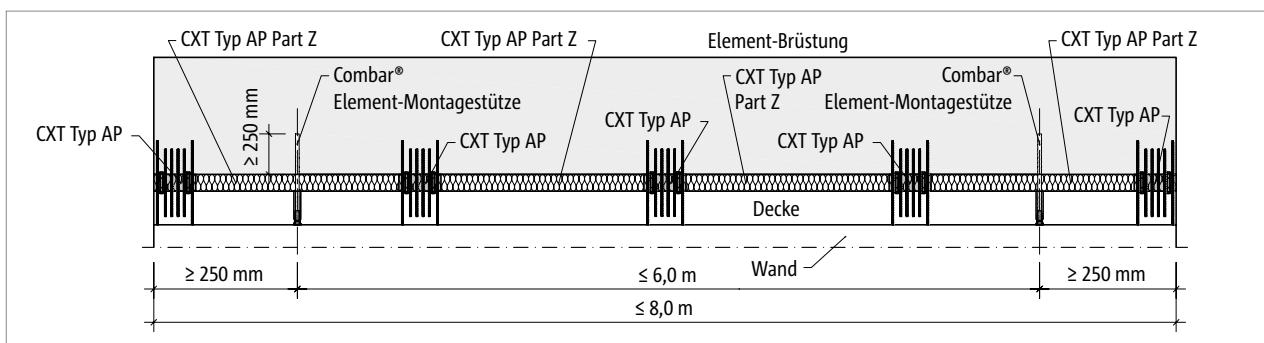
Schöck Isokorb® CXT Typ AP mit Combar® Element-Montagestütze: Randabstände und Mindesteinbindelänge in der Elementbrüstung
